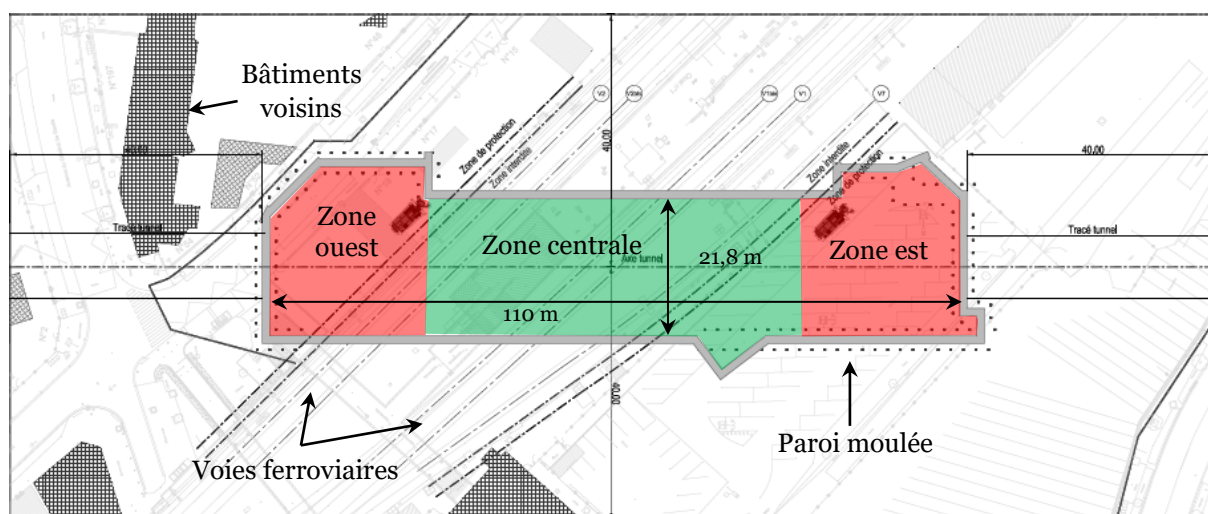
Vue en plan de la gare avec distinction des zones ouest, centrale et est
